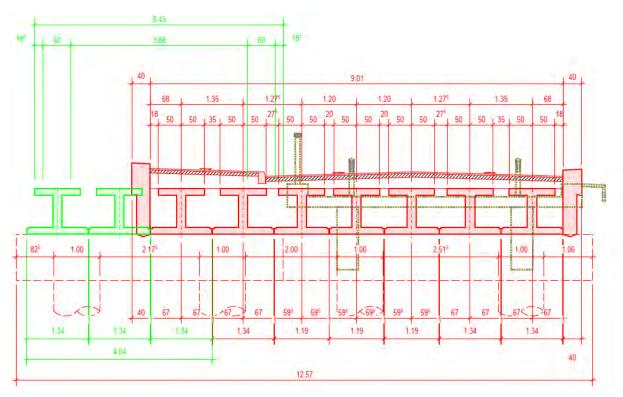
Querschnitt geplantes Brückenbauwerk
